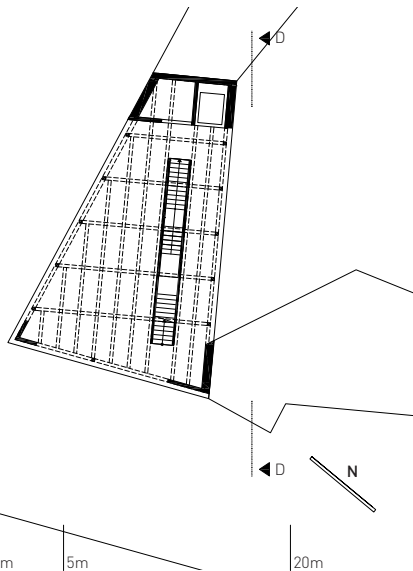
Grundriss Gewächshaus EG +0,00m
